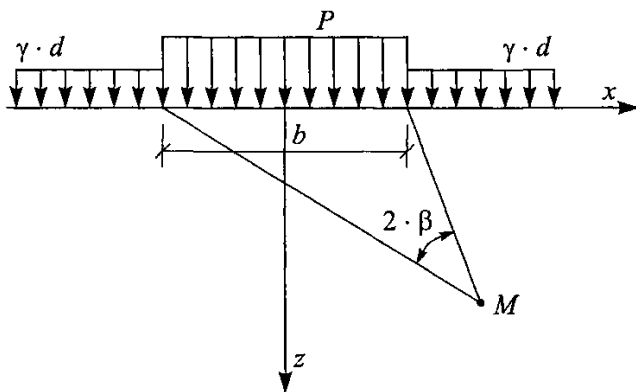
Расчетная схема определения расчетного сопротивления оснований по национальным нормам
